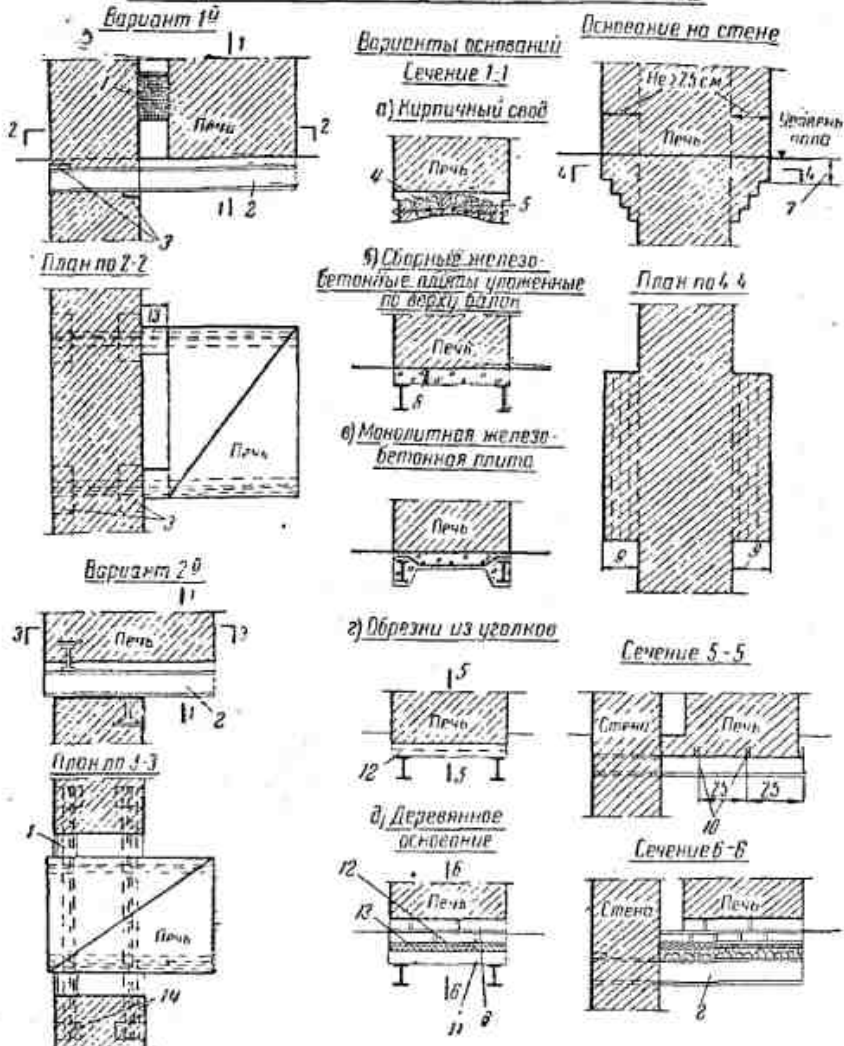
Основание под печи верхних этажей на стене или консольных балках: 1—решетка для притока воздуха; 2—двутавровая консольная балка; 3—металлические подкладки по расвету; 4—кирпичный сводик; 5—стойкий болт диаметром 16 мм; 6—два ряда кирпича с перевязкой швов; 7—не менее 15 см; 8—по расвету; 9—не более 25 см; 10—уголки; 11—деревянный антисептированный настил; 12—кровельная сталь; 13—два слоя войлока, вымоченного в глиняном растворе; 14—опоры по расвету.
